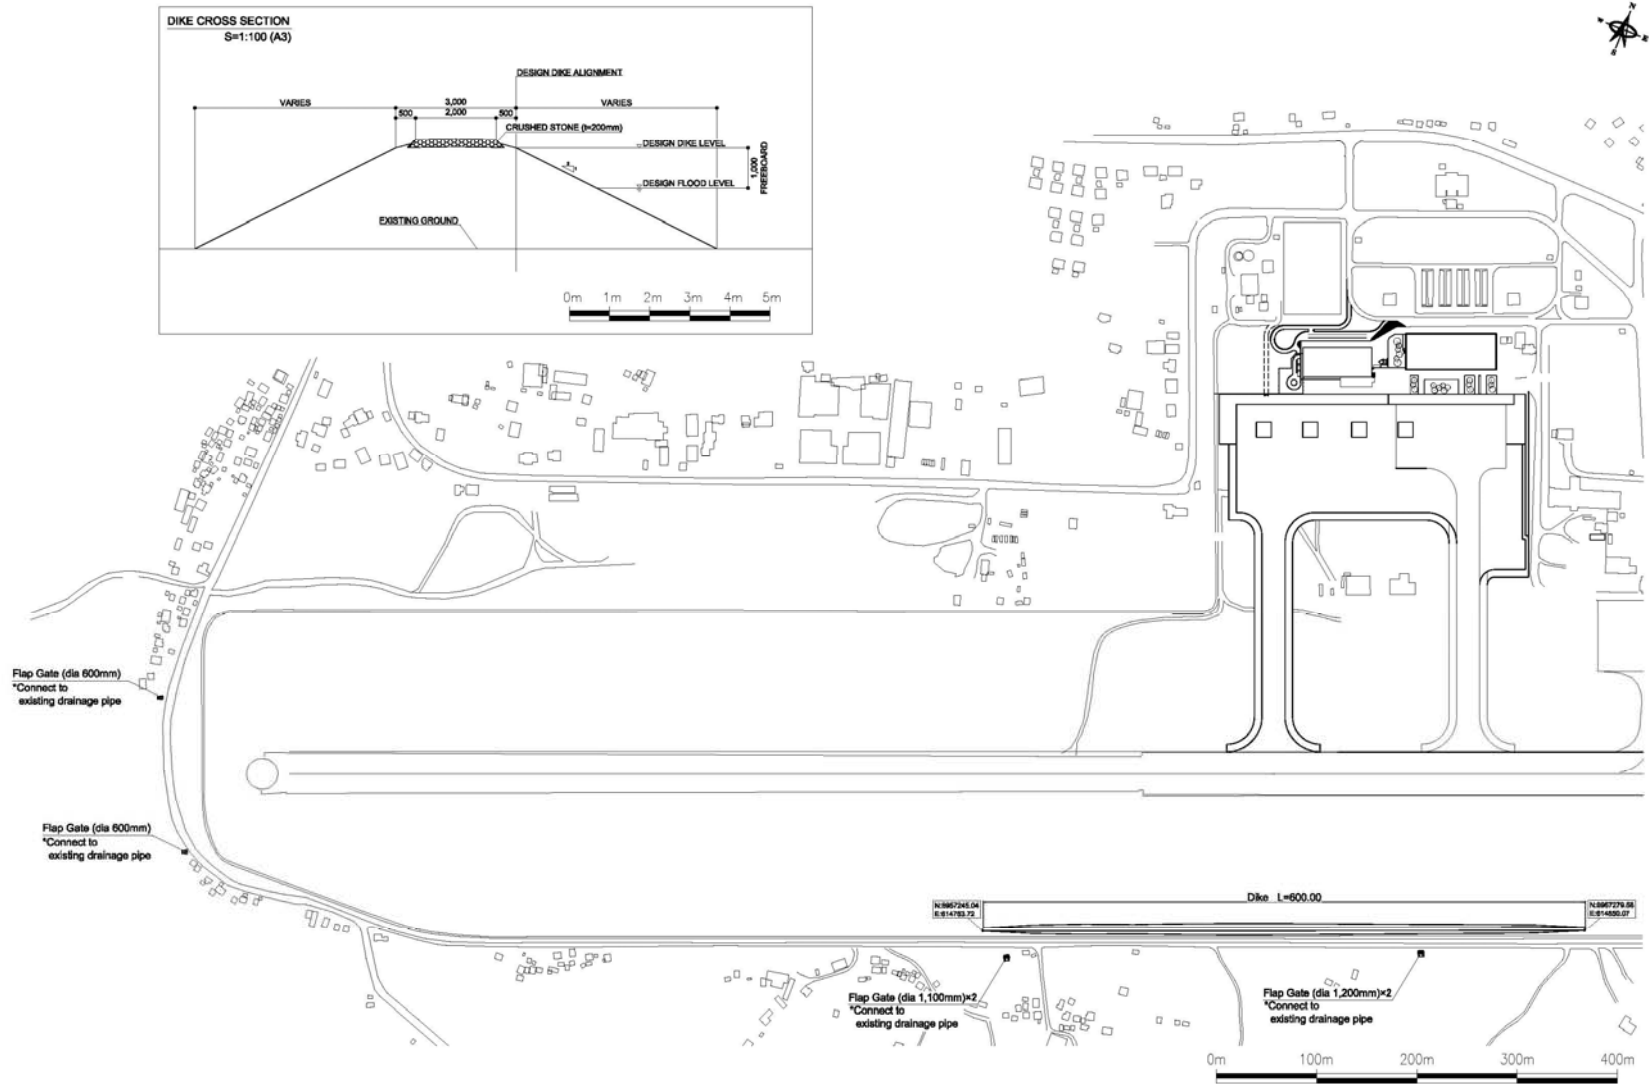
洪水対策施設配置図・洪水対策堤防標準断面図
